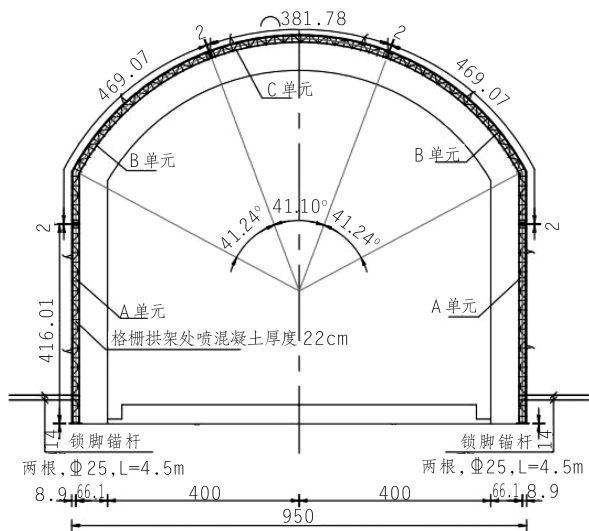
引水1号、5号施工支洞V类围岩钢筋格栅拱架安装设计图(单位:cm)
